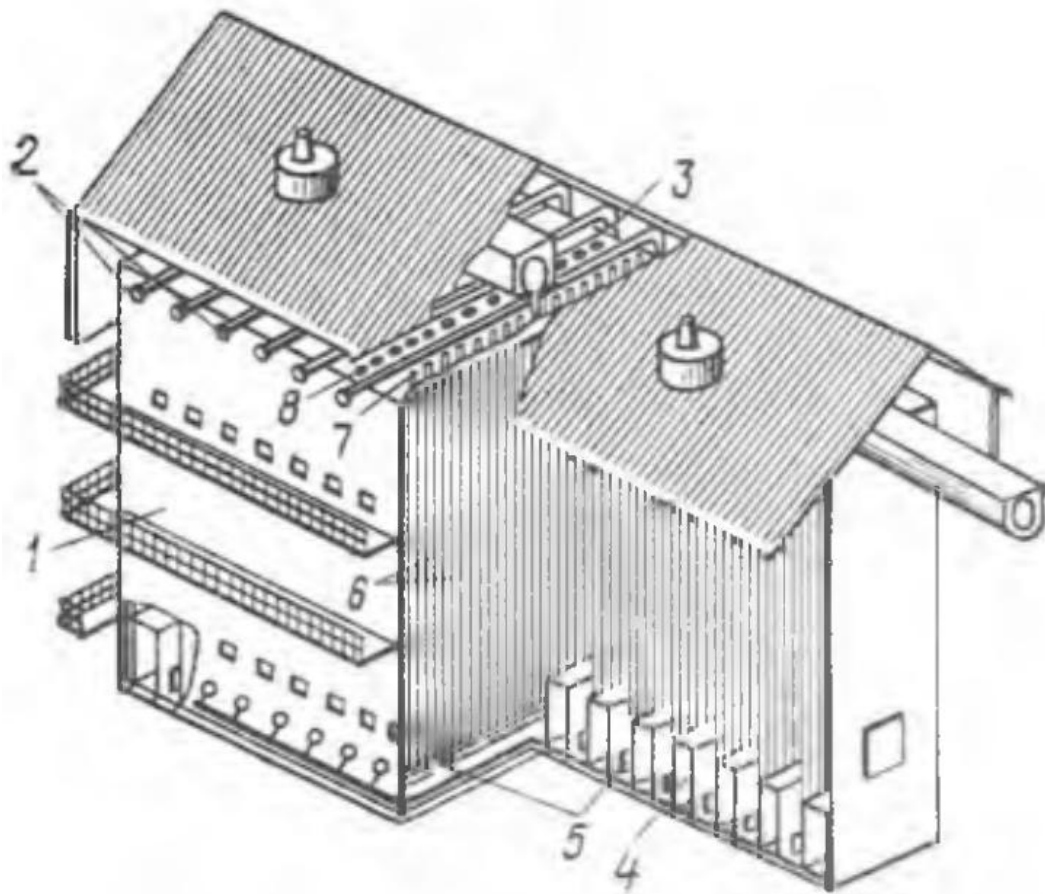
Загальний вигляд топкової камери багатотрубчастої печі:
